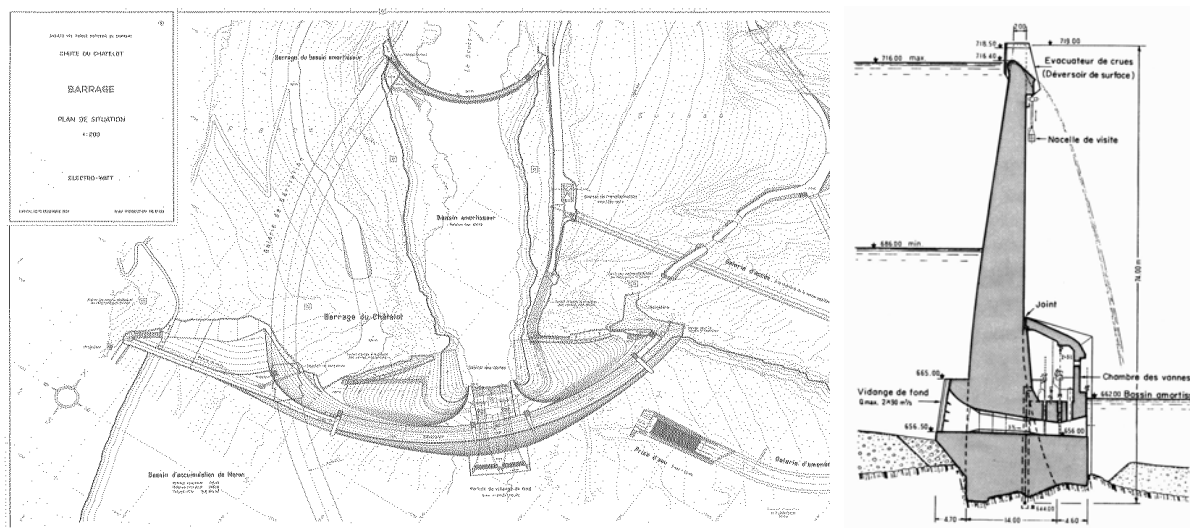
Vue en plan et coupe centrale du barrage du Châtelot.
